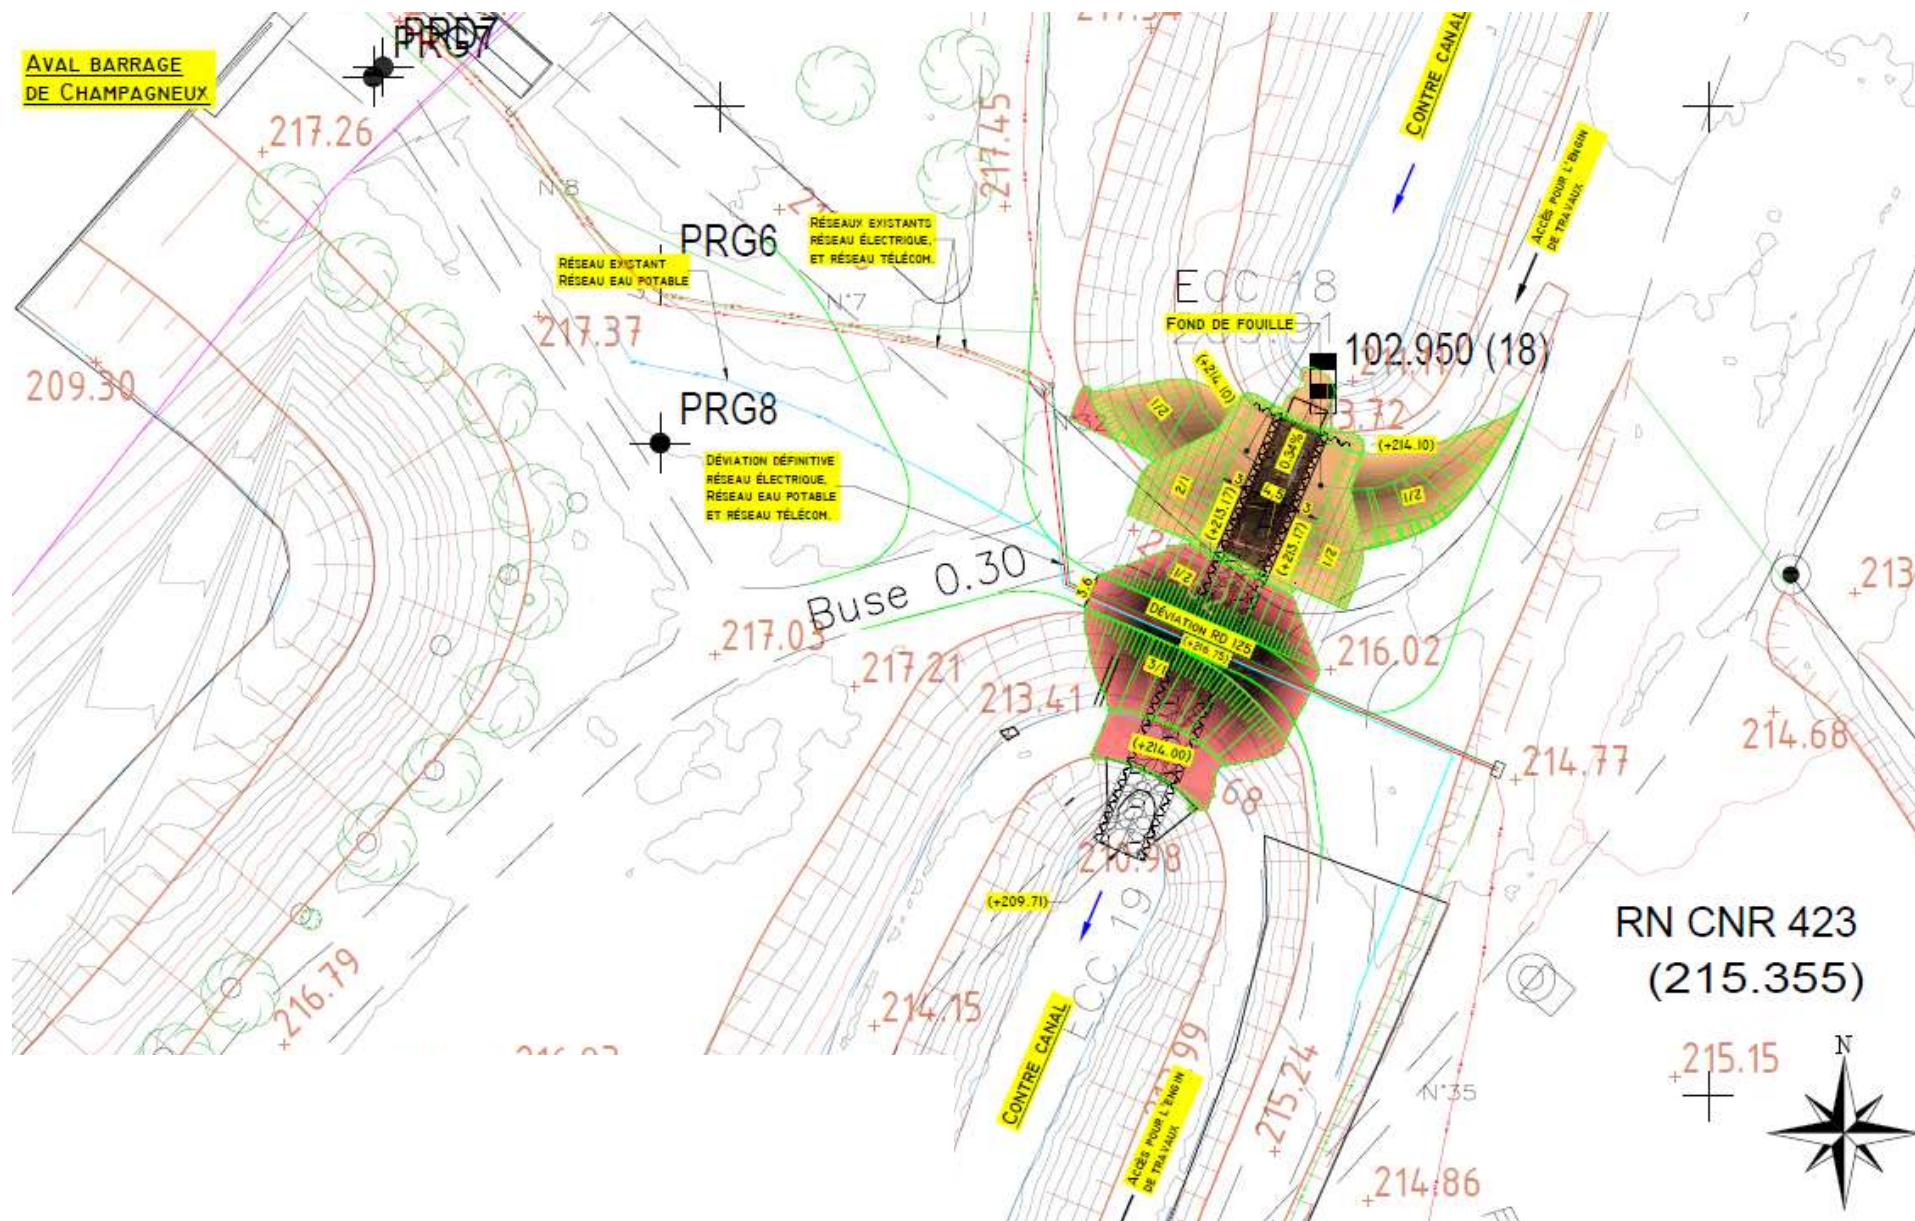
Plans décrivant les travaux – Phase 3.2 – Remplacement de la buse sur la partie amont – Vue en plan.
